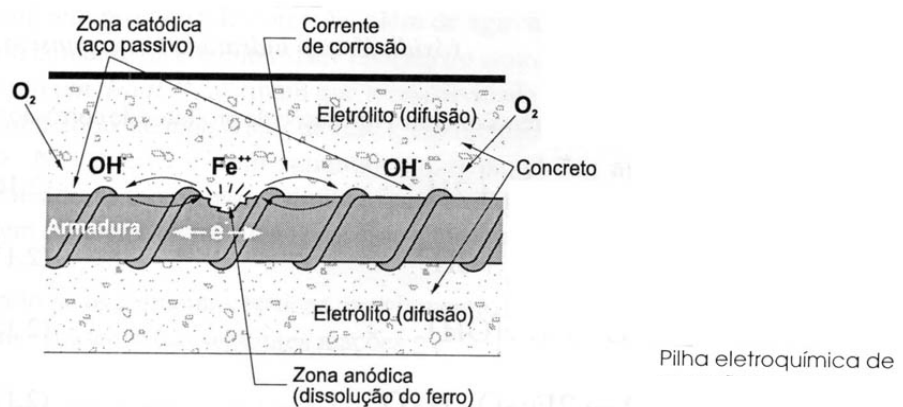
Pilha eletroquímica de corrosão no concreto armado
